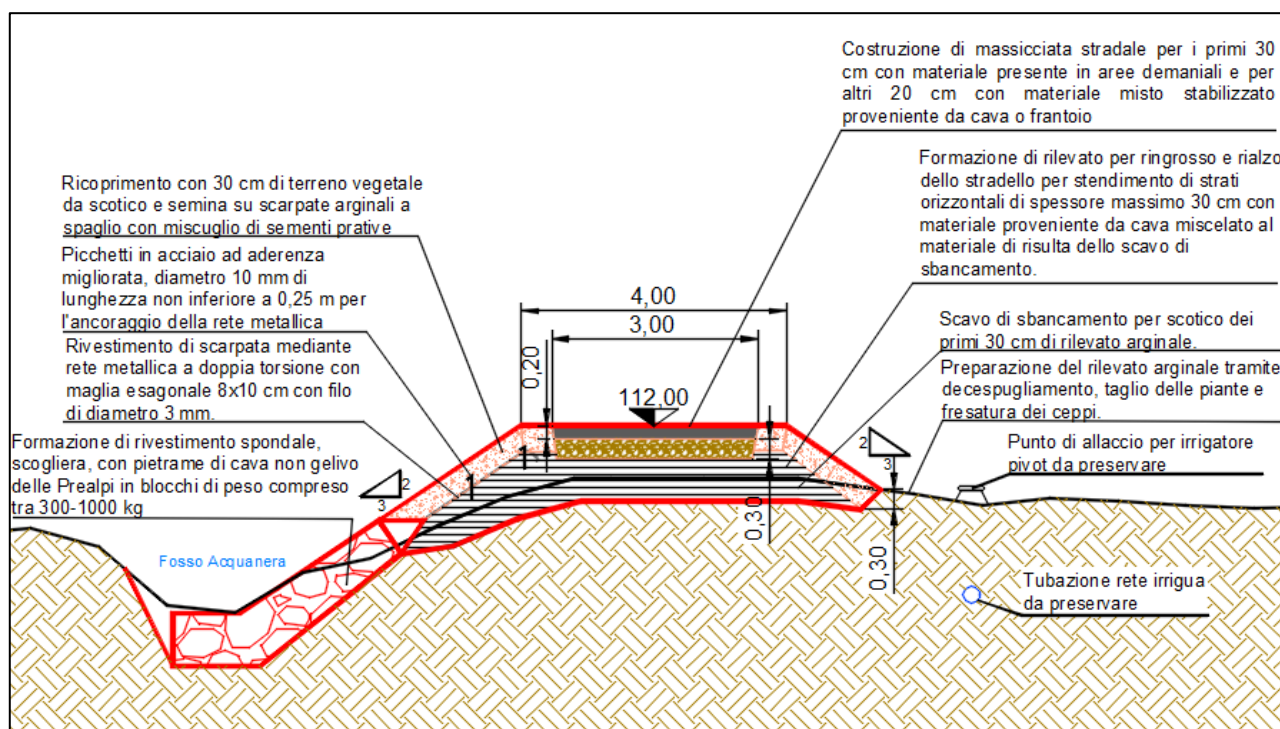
SEZIONE TIPOLOGICA INTERVENTO 2
